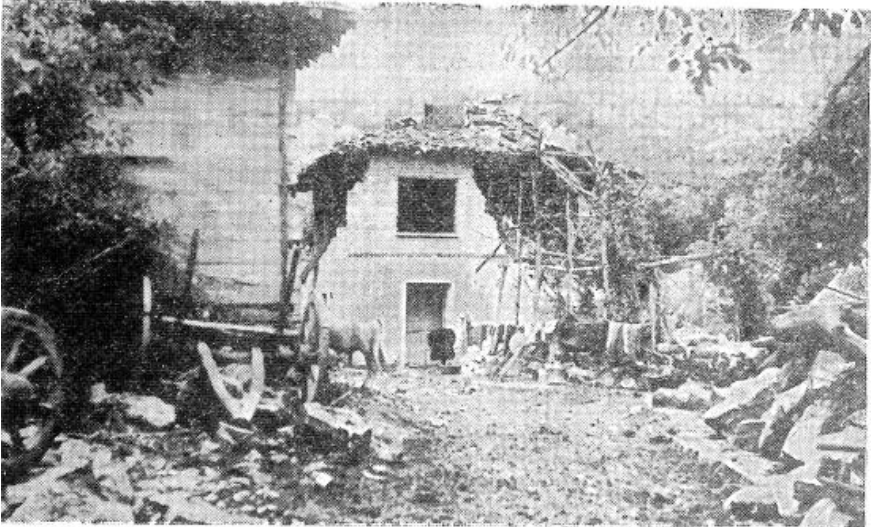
Kirlik köyü Horas mahallesinde fazla hasar görmüş bina.
